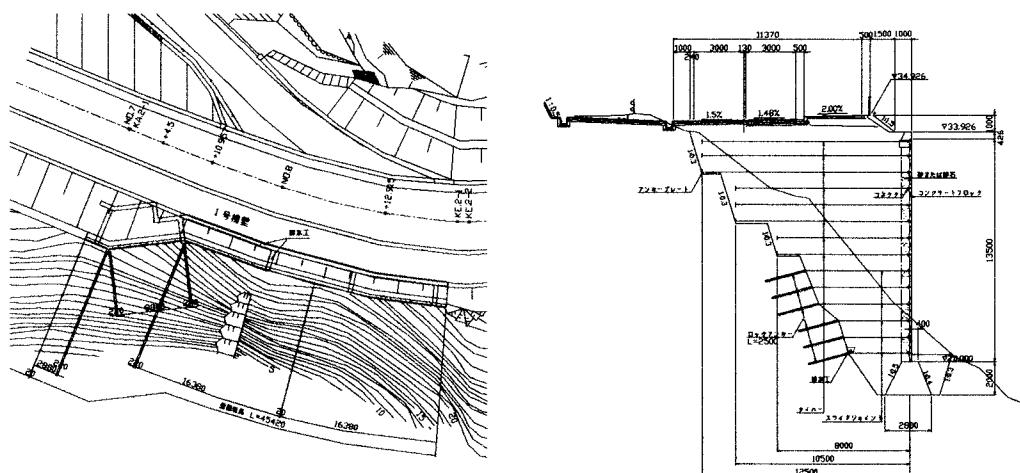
動態観測を実施した補強土壁の平面図と観測位置の断面図
